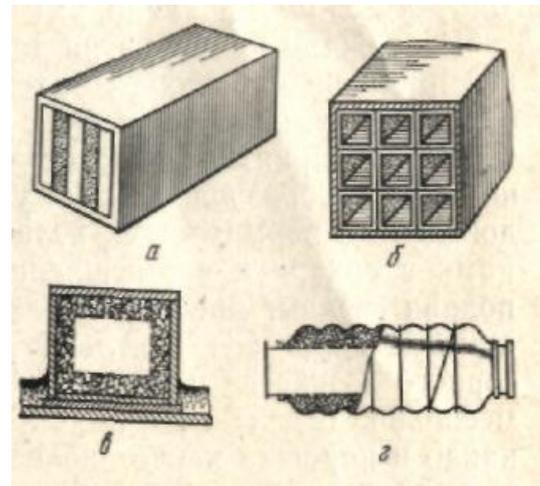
Штучные глушители шума: а – пластинчатый; б – сотовый; в – трубчатый прямоугольной формы; г – круглой формы.
